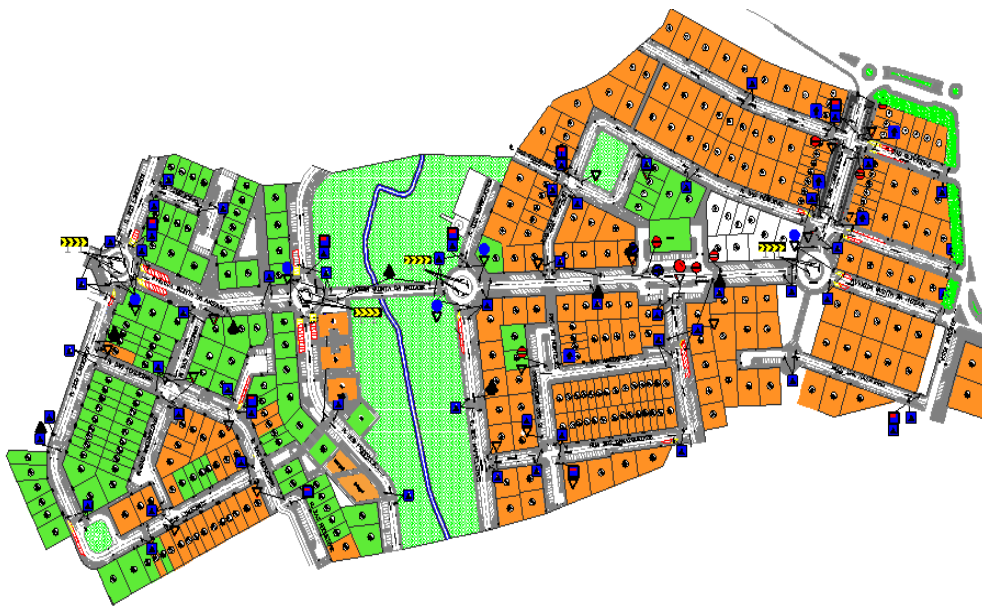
Planta de Reabilitação da Sinalização Vertical e Horizontal
